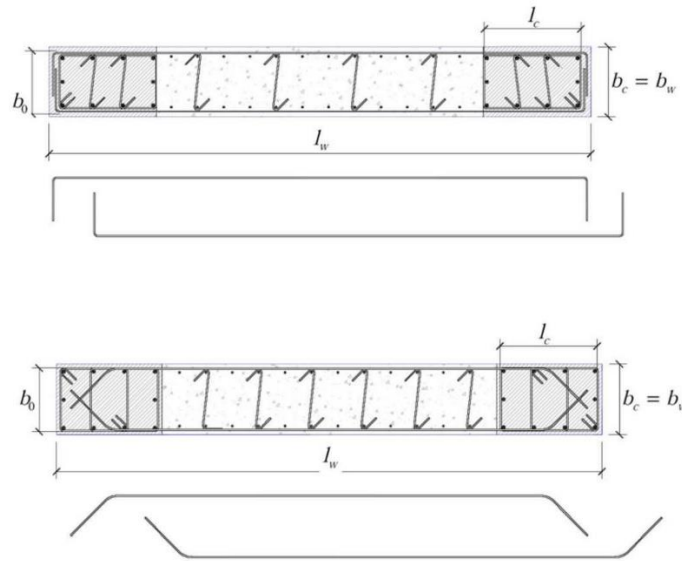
Raste të ankorimit të shufrave horizontale të brinjës së murit
